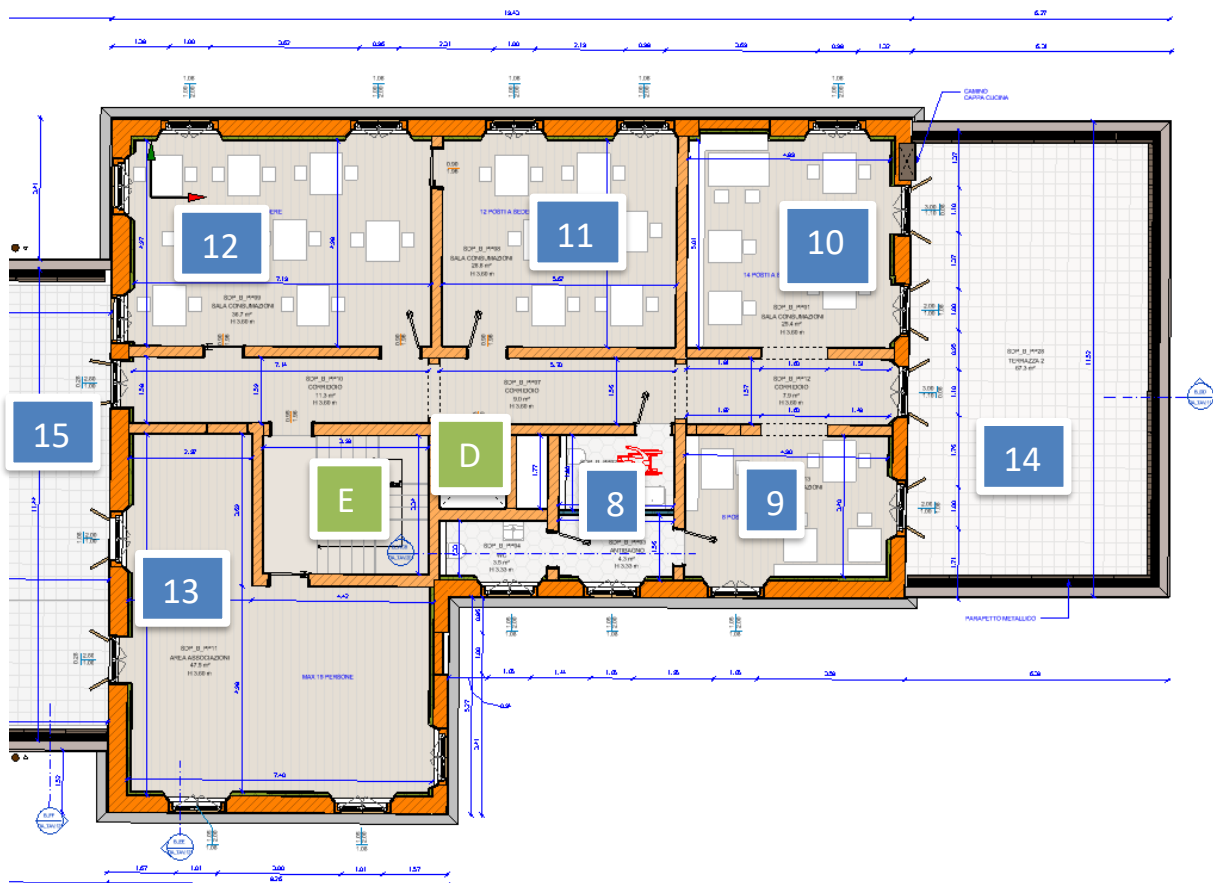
Estratto tavola di progetto – Edificio B pianta piano primo.
